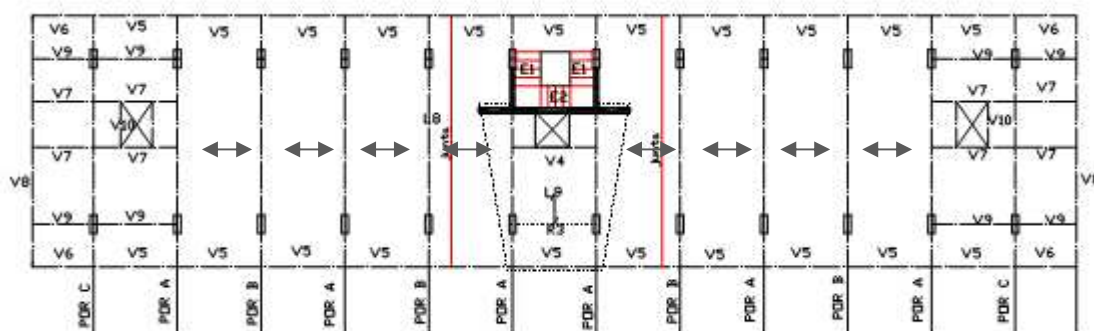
Planta estrutural do R/C (adaptado de Rodrigues, 2005)
